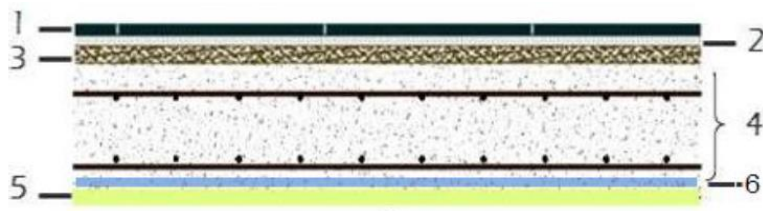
Coupe d'un plancher d'étage courant en dalle pleine.
